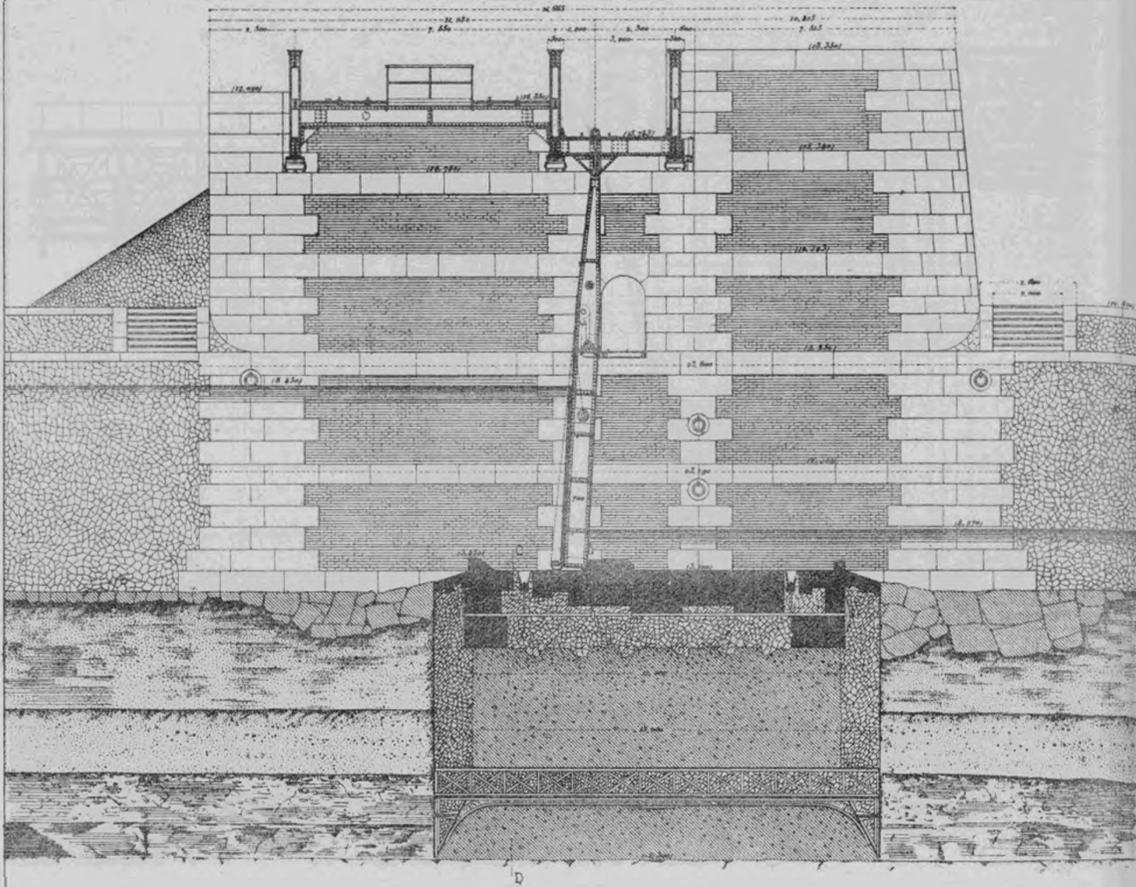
Pile séparative des passes navigables et des passes déversoir. Elévation d'amont et coupe des fondations suivant AB (Fig 3) CD (Fig 1) EF, GH, IJ, (Fig 3)
